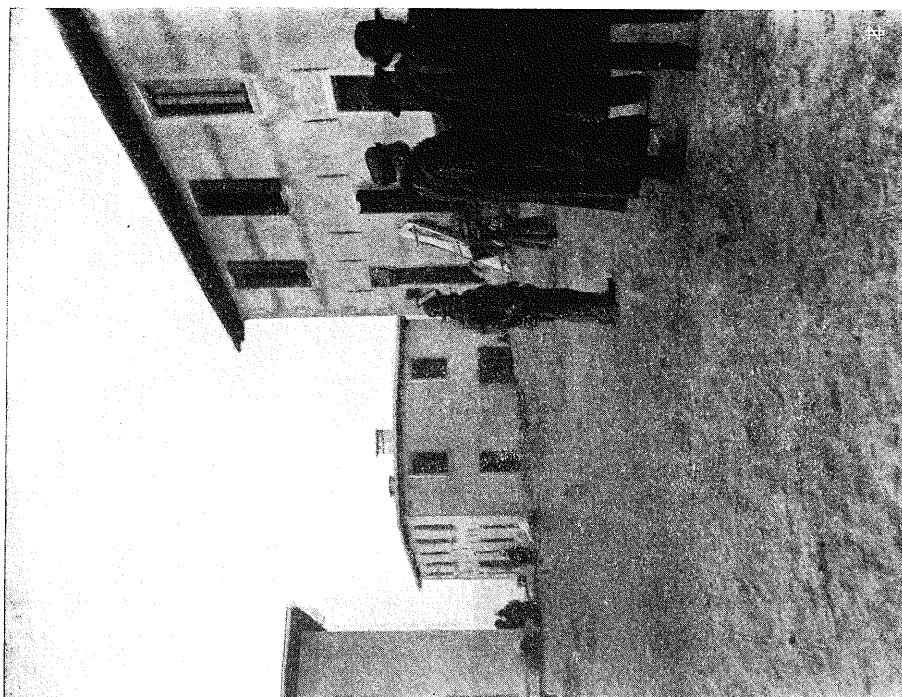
Oase di struttura mista, cemento armato e muratura,
